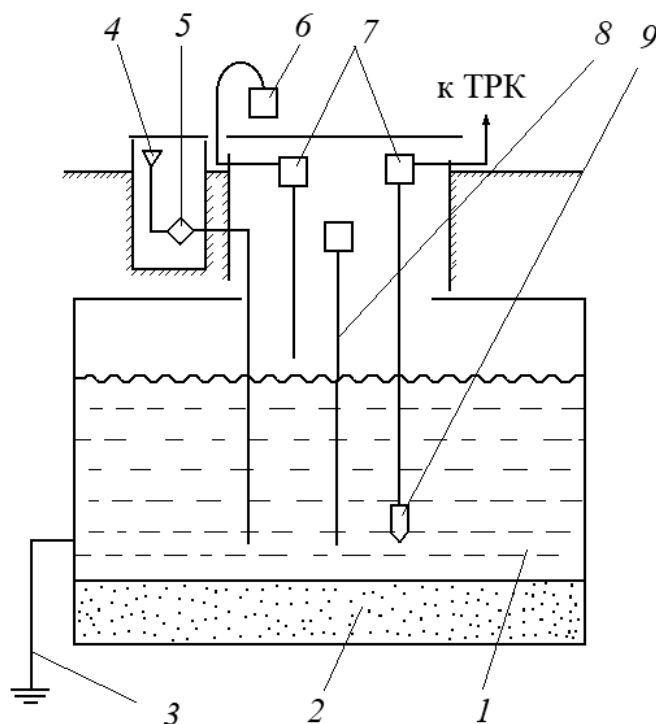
Схема подземного резервуара для хранения бензина: 1 – резервуар; 2 – фундамент; 3 – заземление; 4 – наливное устройство; 5 – сливной фильтр; 6 – концевой огневой предохранитель; 7 – угловые огневые предохранители; 8 – мерное устройство; 9 – обратный клапан
